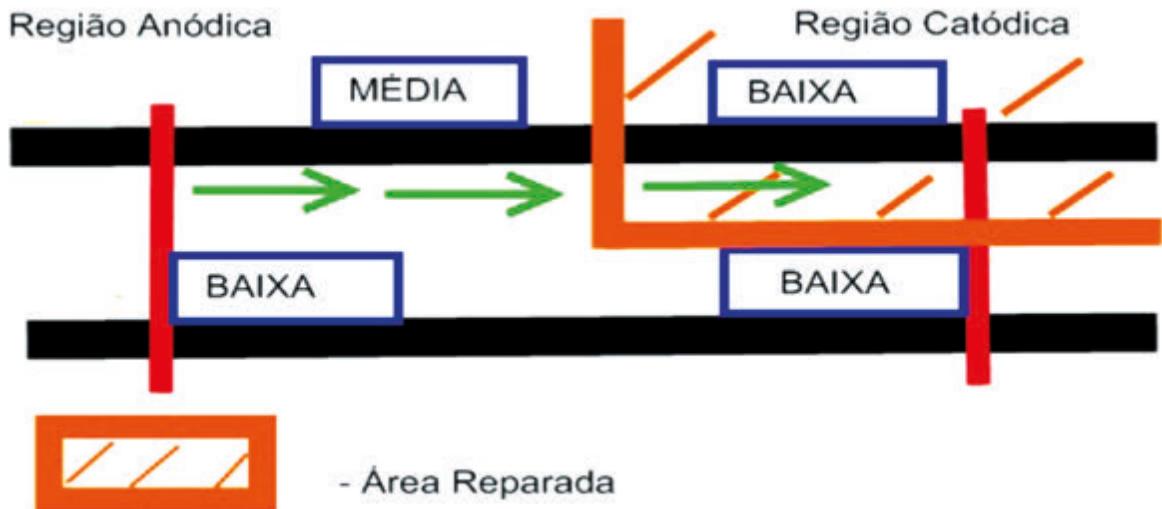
Situação de corrosão em Concreto Armado (Após o Reparo - RE).
